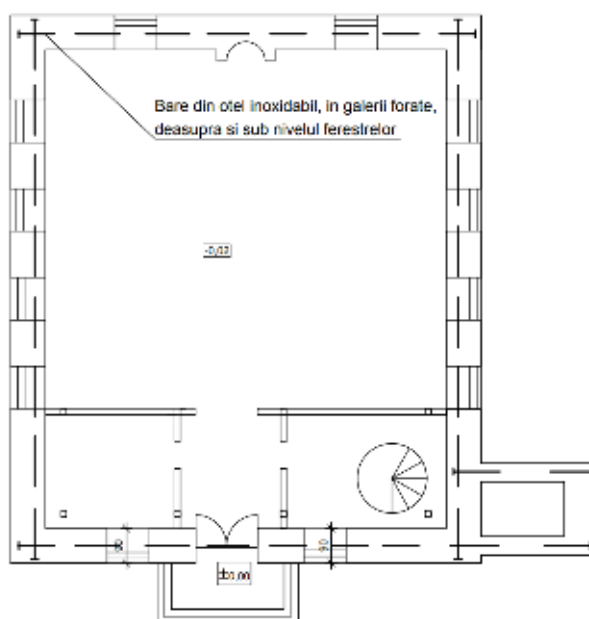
Plan cu dispunerea barelor din oțel pe plan orizontal – geamia Hunchiar
